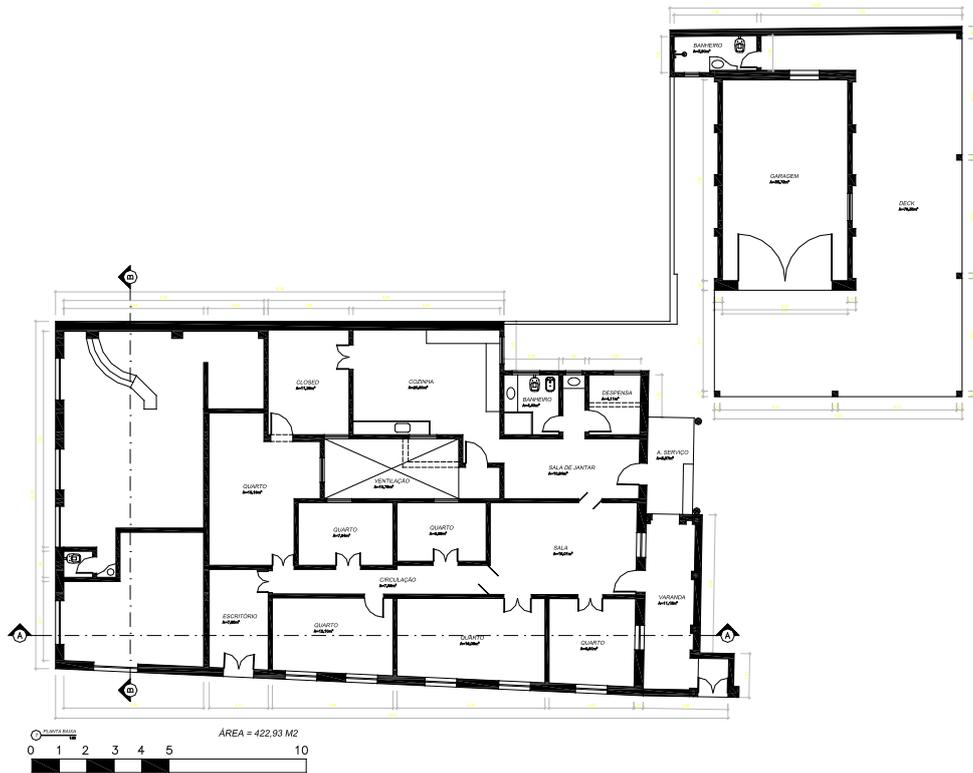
Planta pavimento térreo - Casa Elias Haddad
